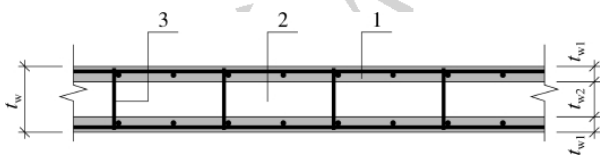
成型钢筋笼叠合板式剪力墙构造示意
